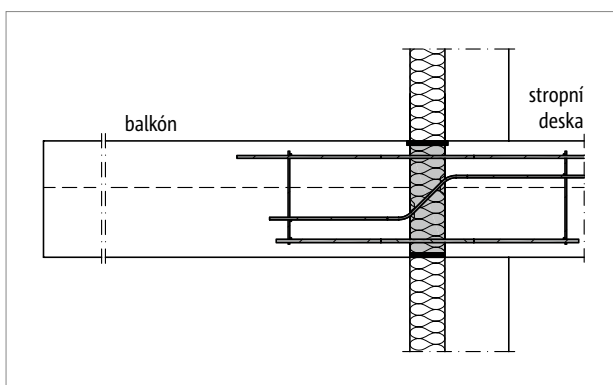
Schöck Isokorb® XT typ BP: Balkónová konstrukce s volně vyloženými průvlaky (prefabrikovaný balkón)
